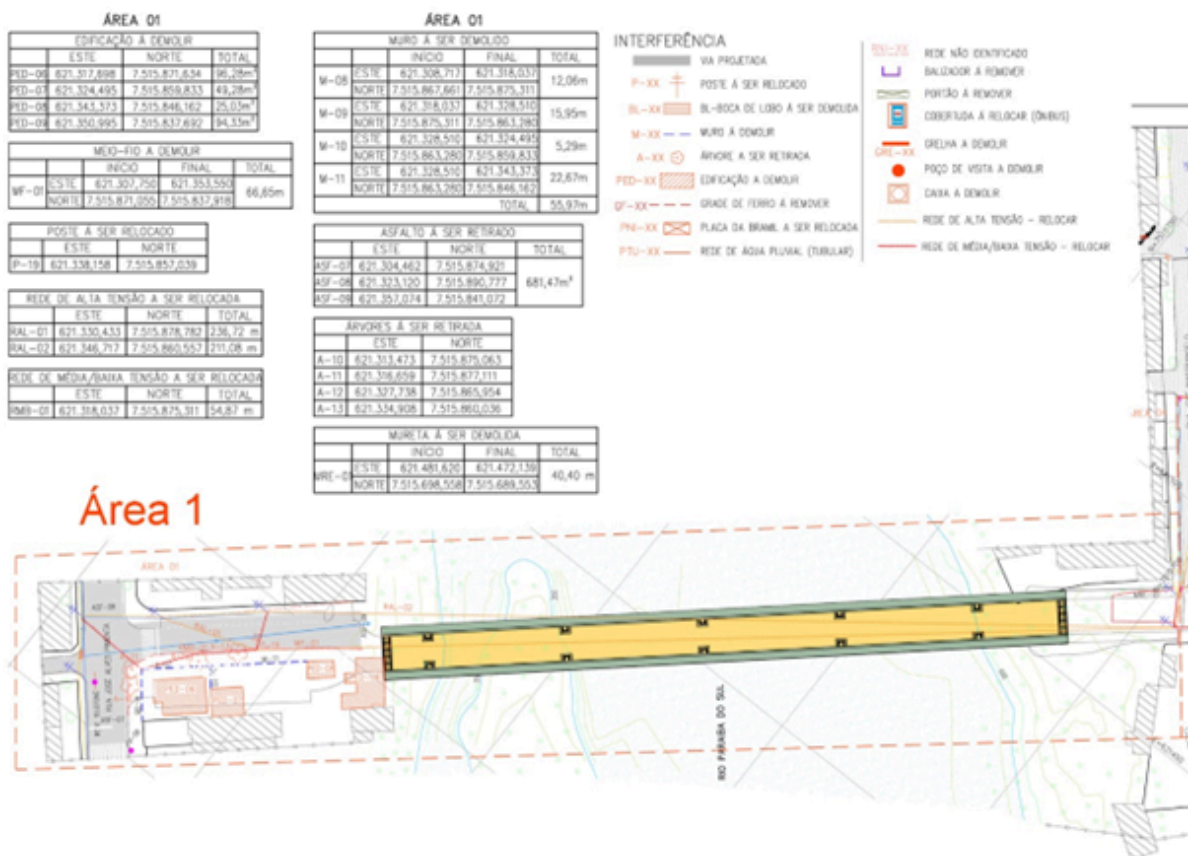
Planta de interferências da Área 1 – Ponte sobre o Rio Paraíba do Sul – Complexo Viário
